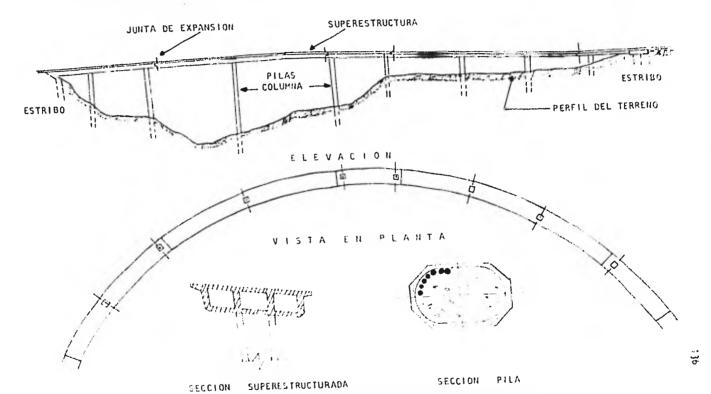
PLANO GENEPAL DE UN PUENTE DE TRAMOS MULTIPLES LARGOS
